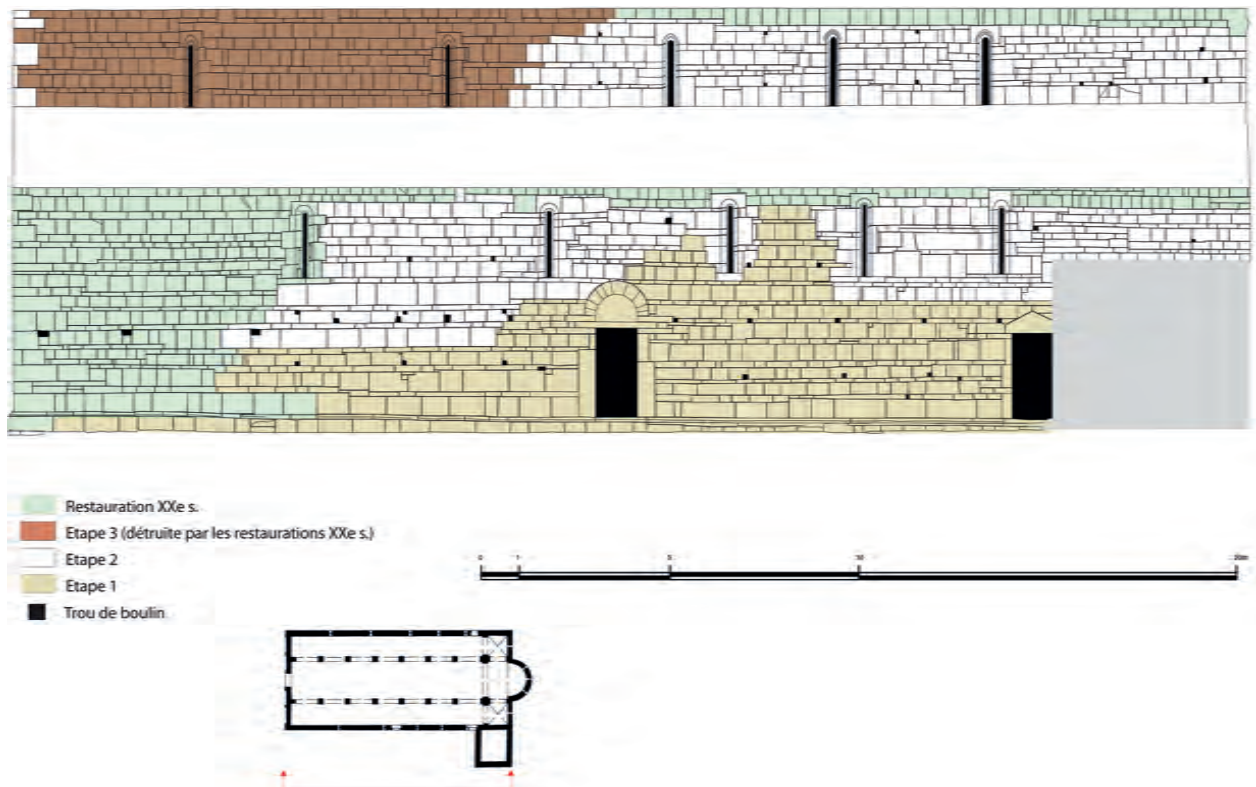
Relevé pierre-à-pierre de la façade sud (extérieure) et étapes de construction (DAO D. Istria/CNRS).
